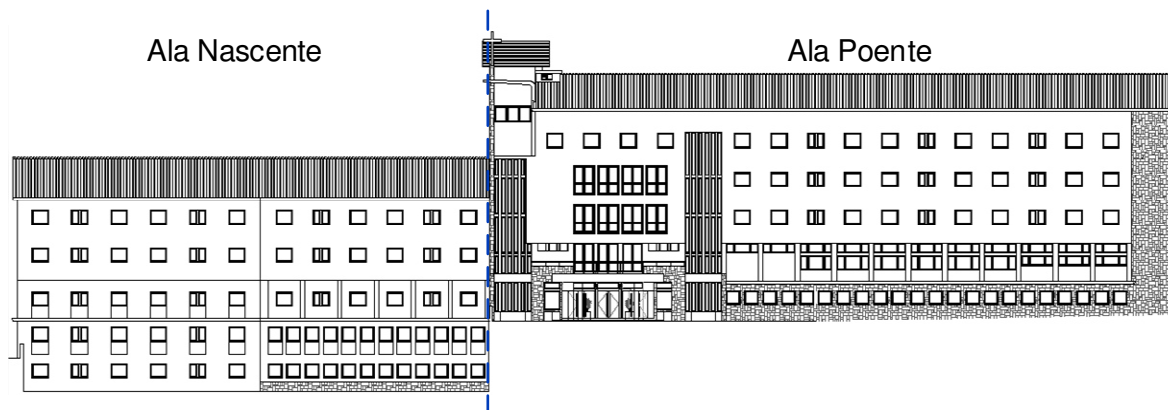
Fachada Norte do Hotel Casa São Nuno.
